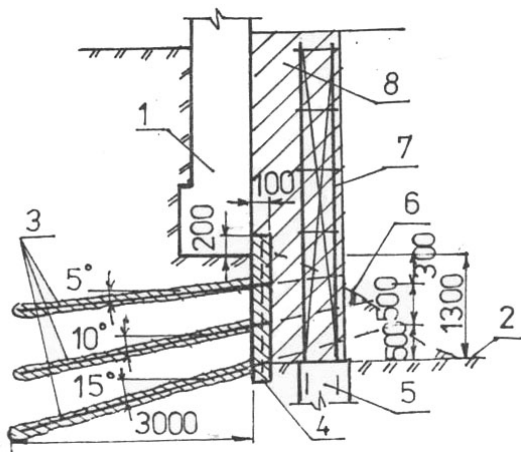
Нагельные крепления под фундаментами дома возле котлована станции метро «Купаловская»
